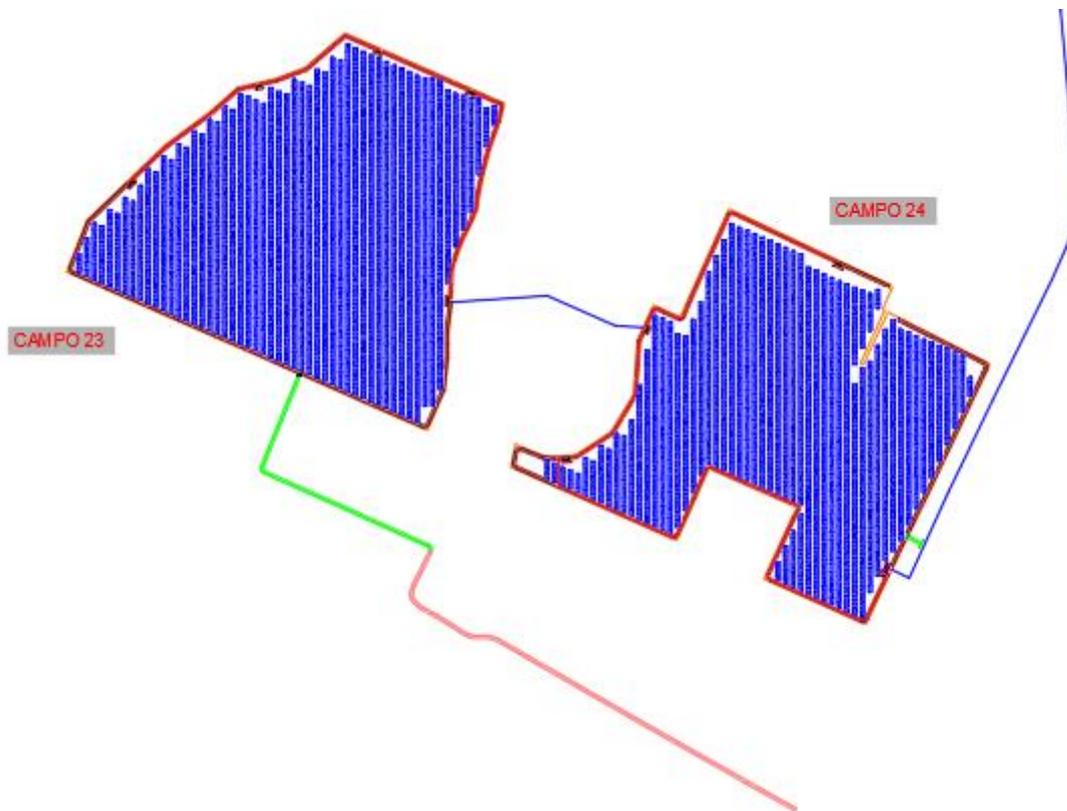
Schema layout dell'impianto – Vista Gruppo 3: Campi 23, 24.
